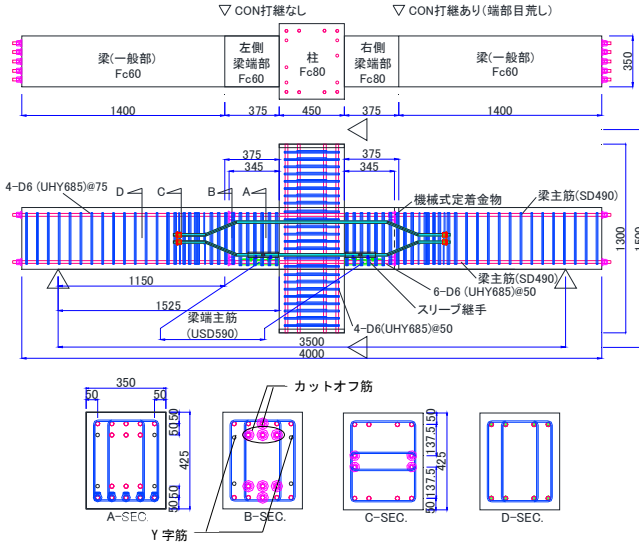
YJ-1 部分骨組実験試験体の形状・配筋
